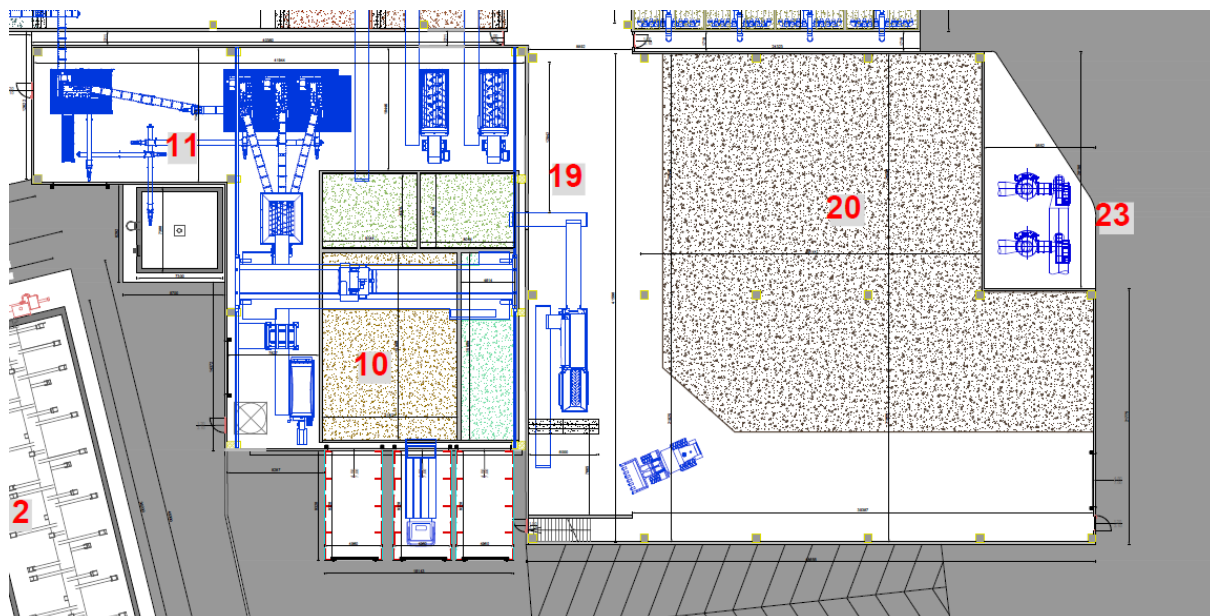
Stralcio tav. 012 – Planimetria generale di progetto
